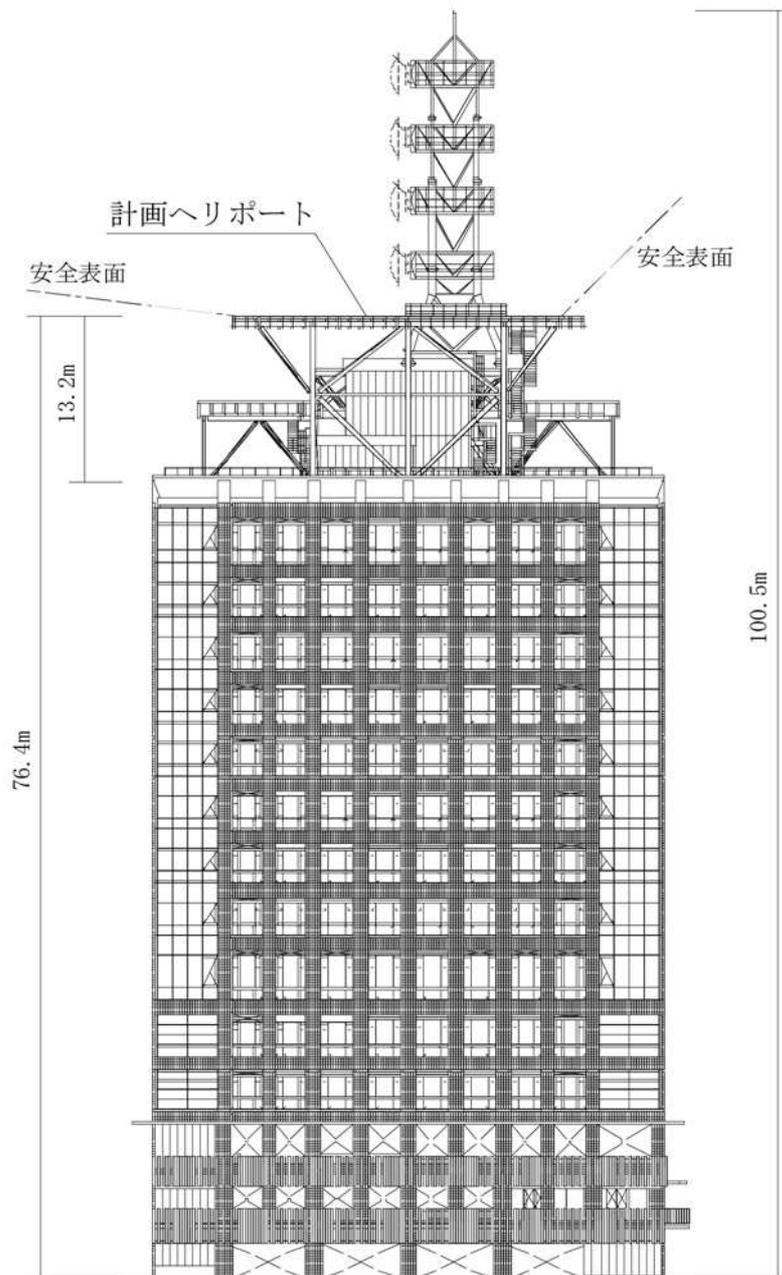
計画ヘリポート設置建築物の北側立面図
